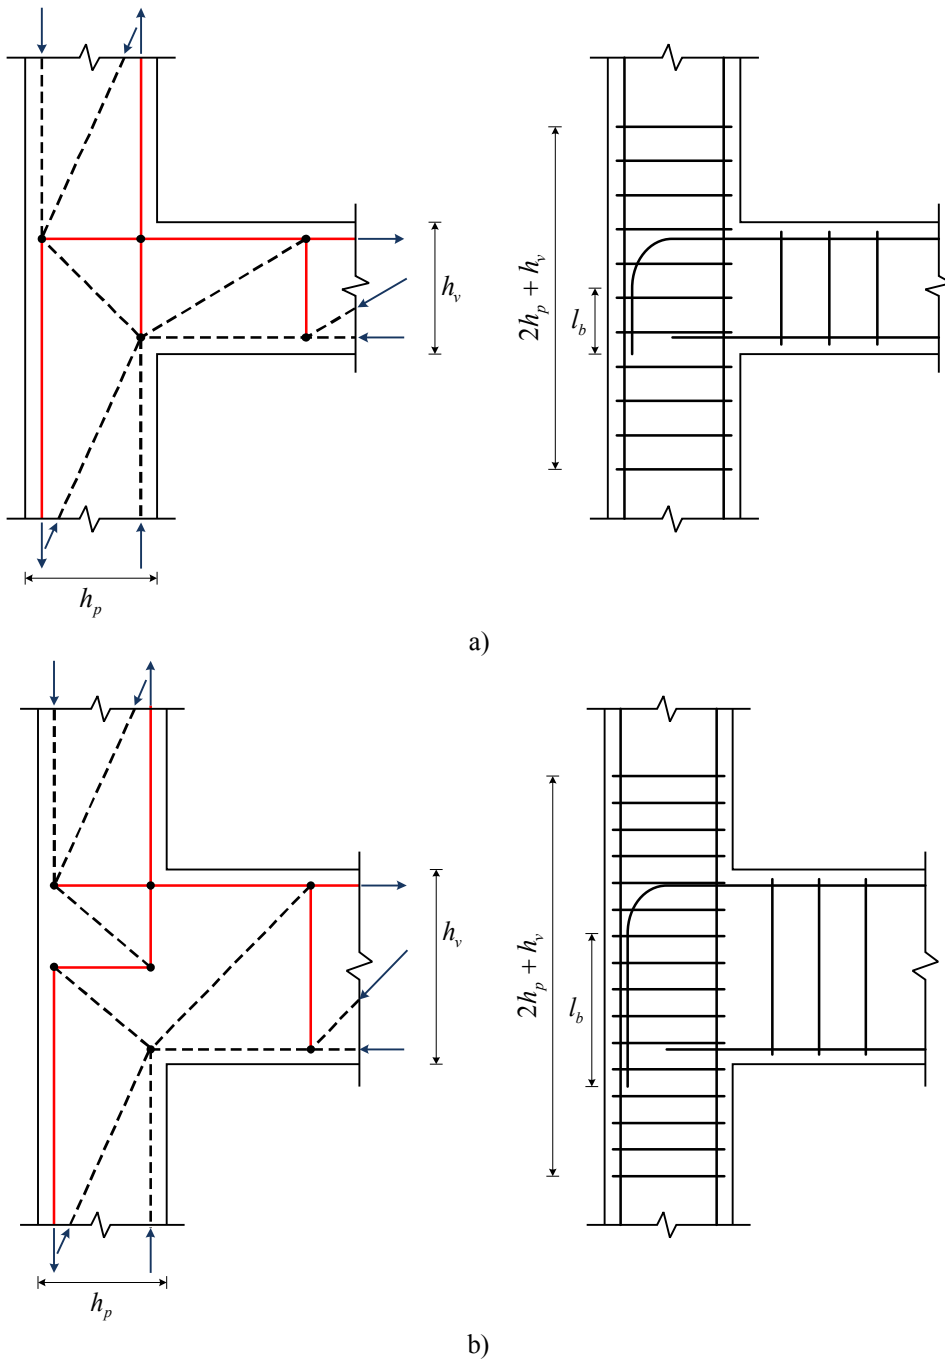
Modelos Normativos da ligação de viga intermediária-pilar extremo (Silva, 1991):
